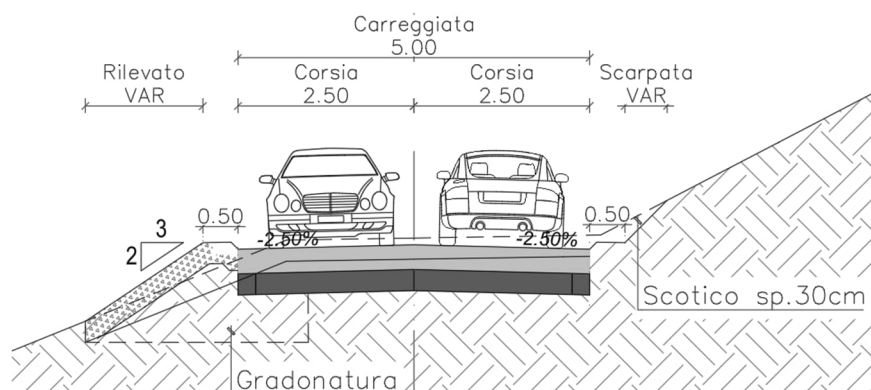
Sezione trasversale del tracciato secondario in sponda destra idraulica
